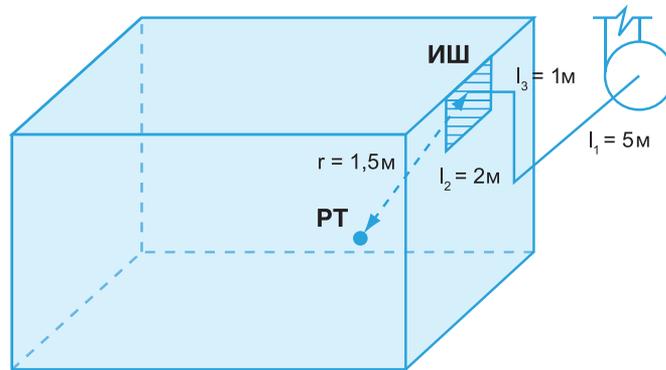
Расчетная схема для определения уровней шума в помещении при работе вентиляционной системы
